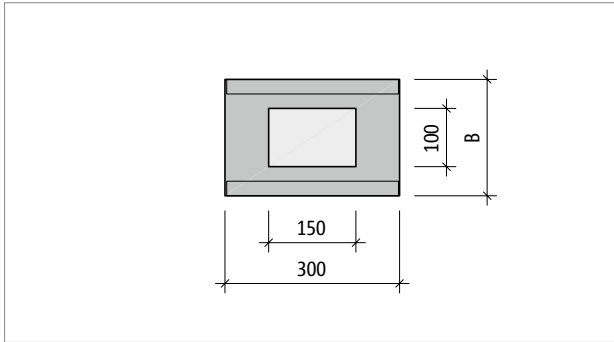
Schöck Sconnex® Typ W-N: Produktgrundriss; Drucklagerfläche 150 mm × 100 mm
